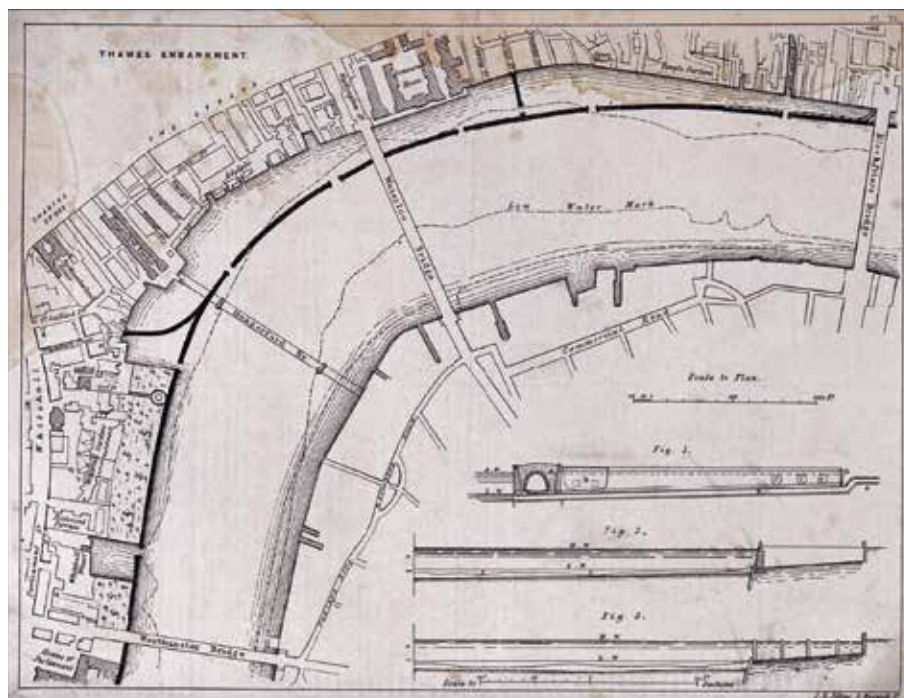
Planos del proyecto de encauzamiento de Joseph Bazalgette.
